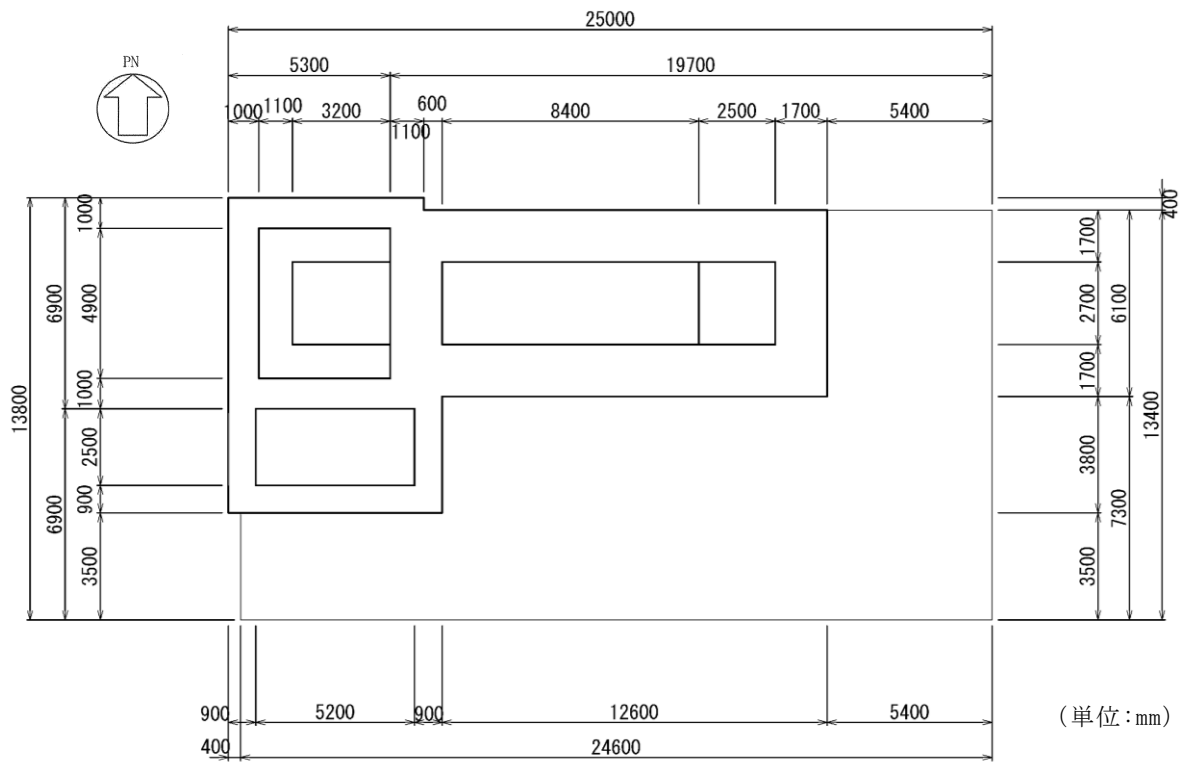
第 1 ベントフィルタ格納槽 平面図 (EL 16.00m)
